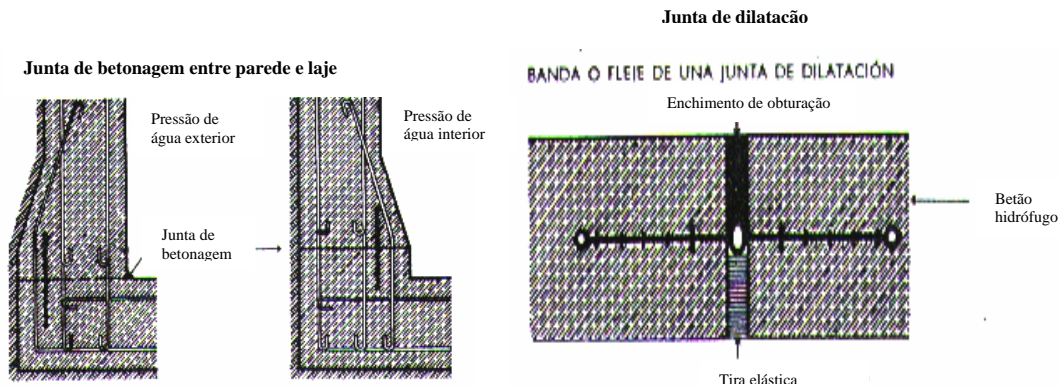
Pormenores de juntas de betonagem e dilatação entre elementos em betão hidrófugo.
